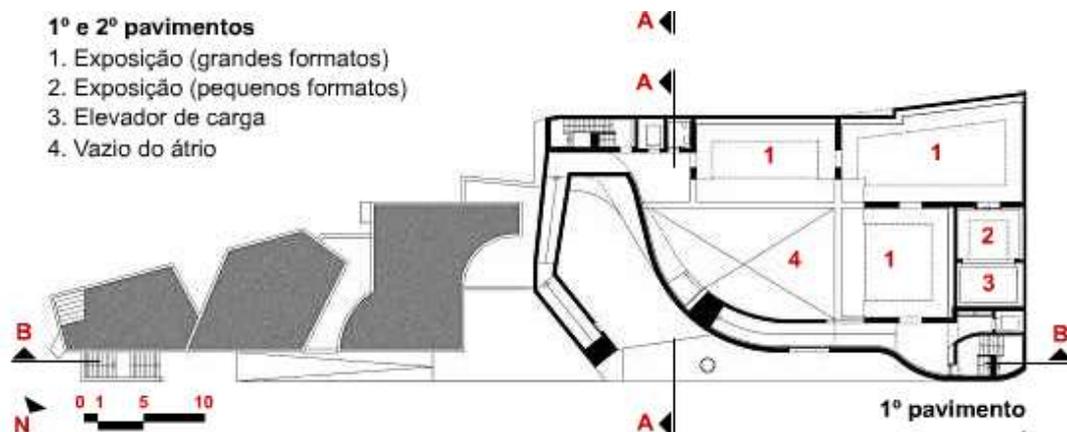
Planta baixa do 1º pavimento (Fonte: ARCOWEB, 2011)
